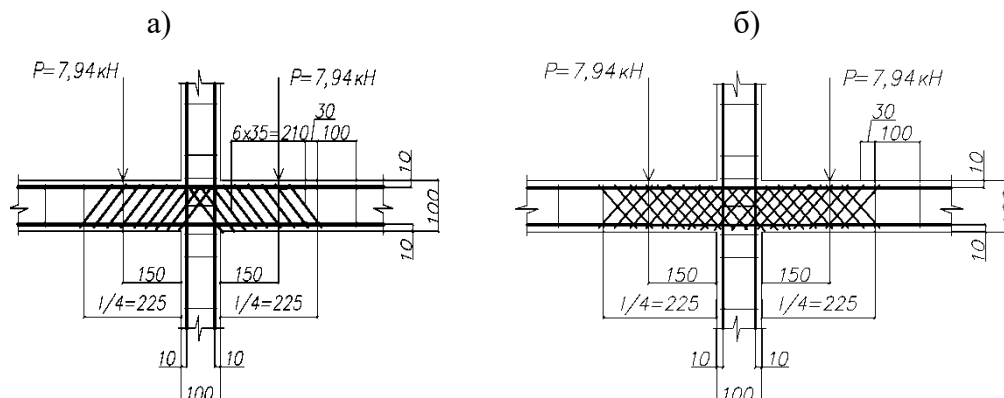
Схема приопорного узла, армированного наклонными стержнями, рама РЖ-1 (а) и с перекрестной схемой армирования, Рама РЖ-2 (б)
